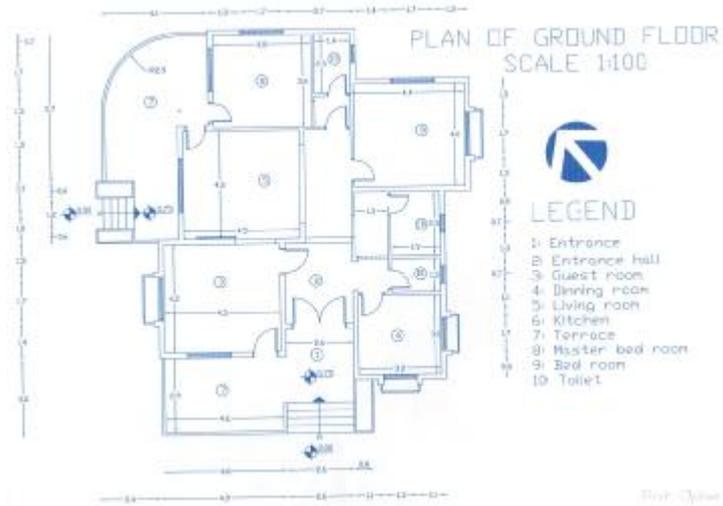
يوضح طريقة اظهار المسقط الأفقي
